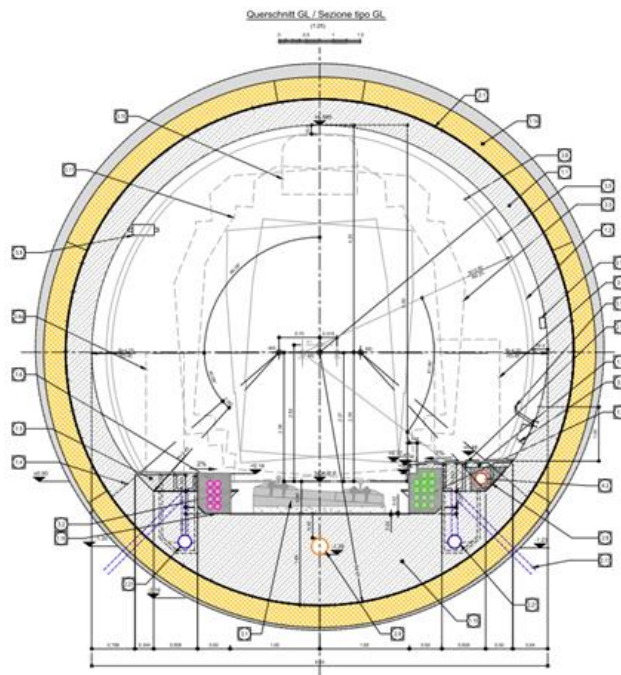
Haupttunnel mit Innenschale und Gegengewölbe aus Ortbeton
